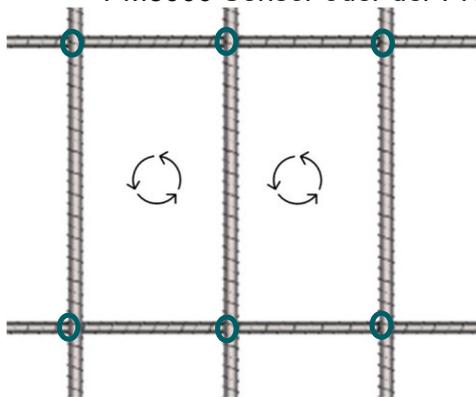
Geschweißte oder verdrahtete Bewehrungsstäbe
